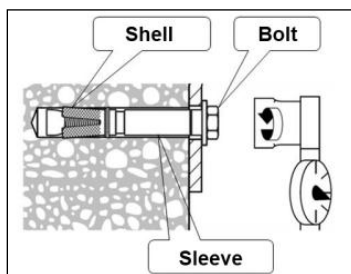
Ancrage HSLG utilise pour la poutre BC4
